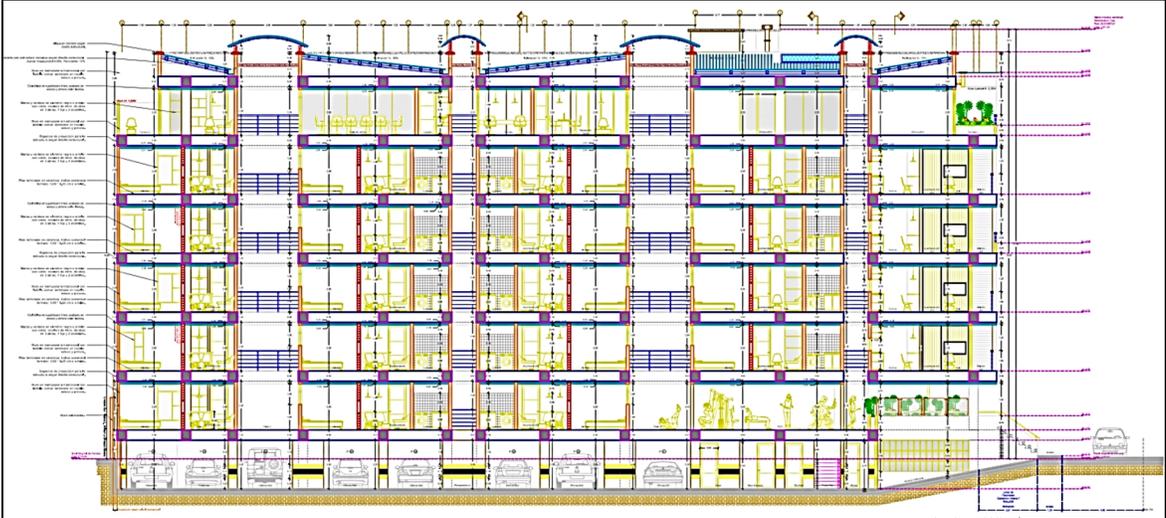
, Corte Arquitectónico, Fuente: Constructora Open House.
